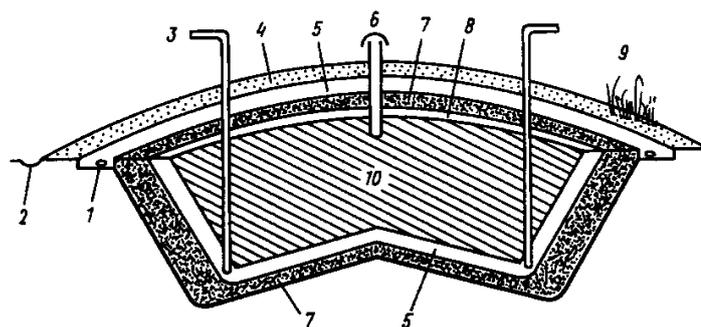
Схема безопасной свалки с системой верхнего и нижнего покрытий, обеспечивающих сбор и удаление жидкости [6]: 1 – слив фильтрата; 2 – сливная канава; 3 – удаление жидкости; 4 – грунт; 5 – проницаемый слой; 6 – газовая вентиляция; 7 – непроницаемый слой; 8 – подложка; 9 – растительность; 10 – опасные отходы
